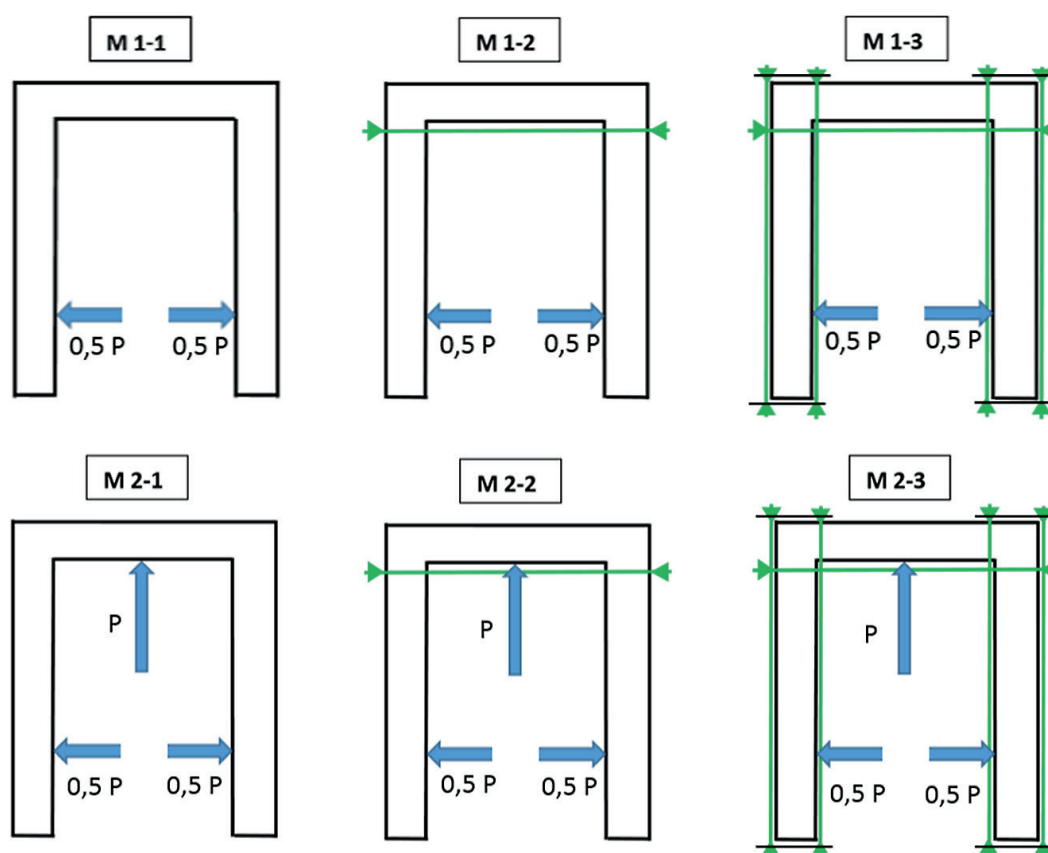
Этапы усиления и испытания опытных железобетонных моделей
